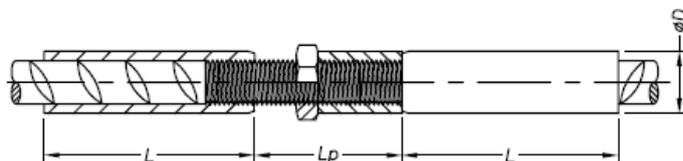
POSITIONSVERBINDUNG (PI) (Alternativ)
